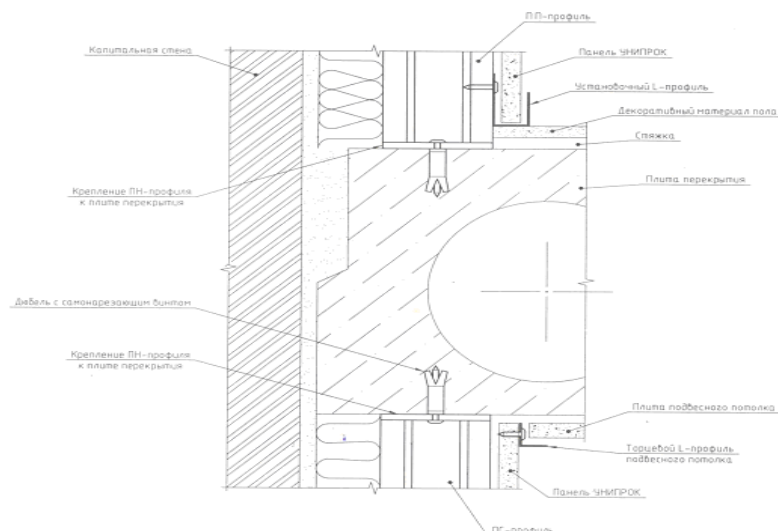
Схема примыкания панелей к межэтажным перекрытиям
